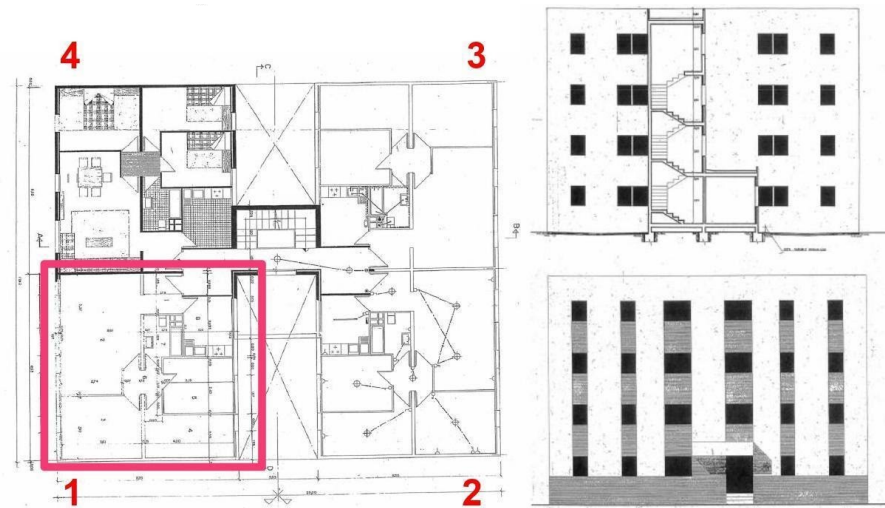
Plano de planta donde se muestran las viviendas por piso (obtenida de Serrano Lanzarote 2016)
